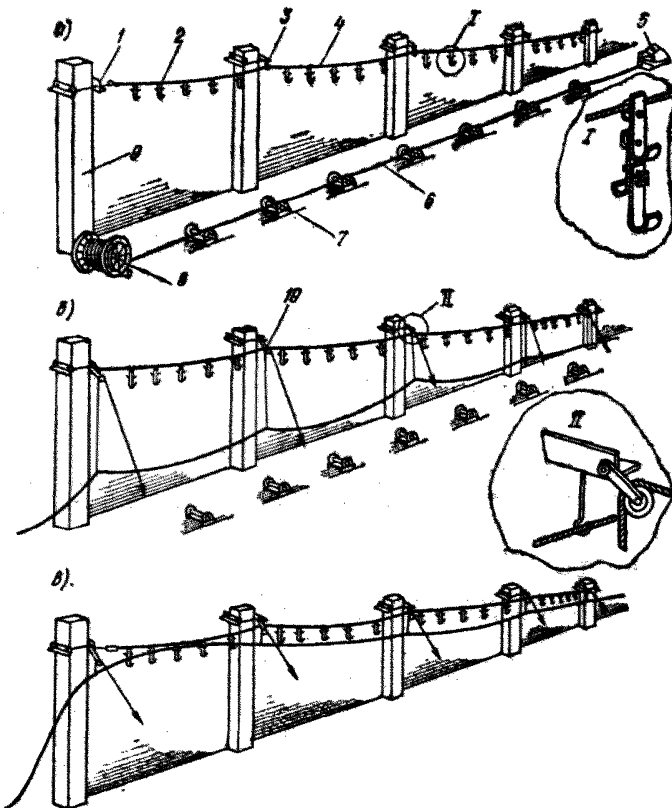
Схема раскатки, подъема и укладки кабеля в подвесные кабельные конструкции
